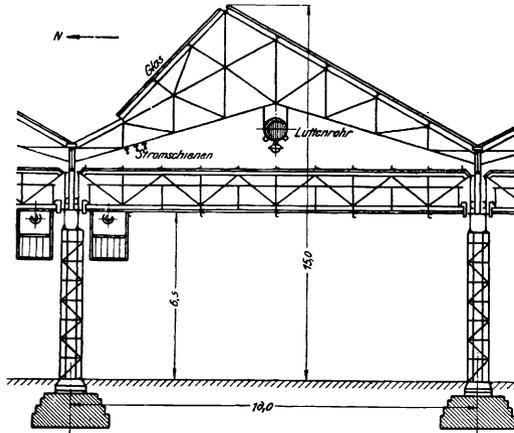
Querschnitt durch ein Schiff des Grobwalzwerkes (Halle 52) mit dem Lüftenrohr nebst Beleuchtungskörper über dem Kran und mit den Stromschienen.
